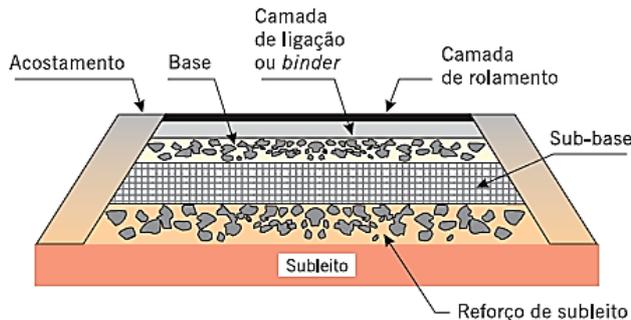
Seção transversal de um pavimento asfáltico. Fonte: Bernucci L.B., et al (2006)<sup>3</sup>.
